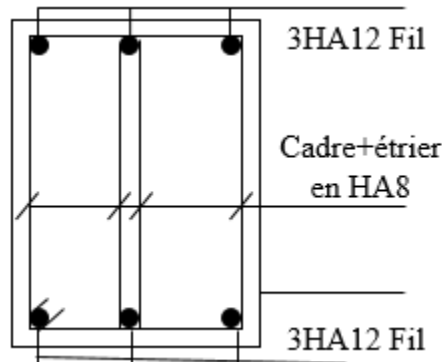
Ferraillage aux appuis d'une poutre de chaînage.
